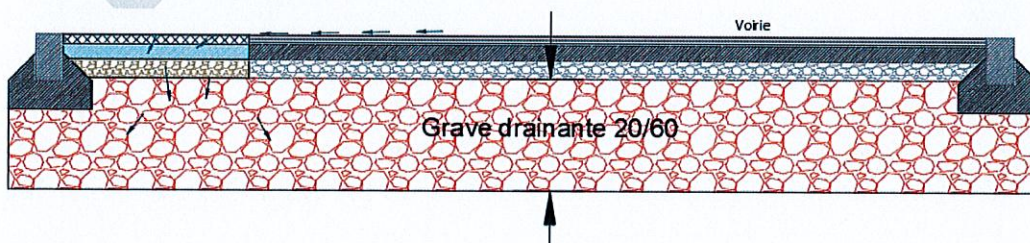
Exemple d'une coupe d'une chaussée réservoir avec injection par bande poreuse (INFRA Services)
